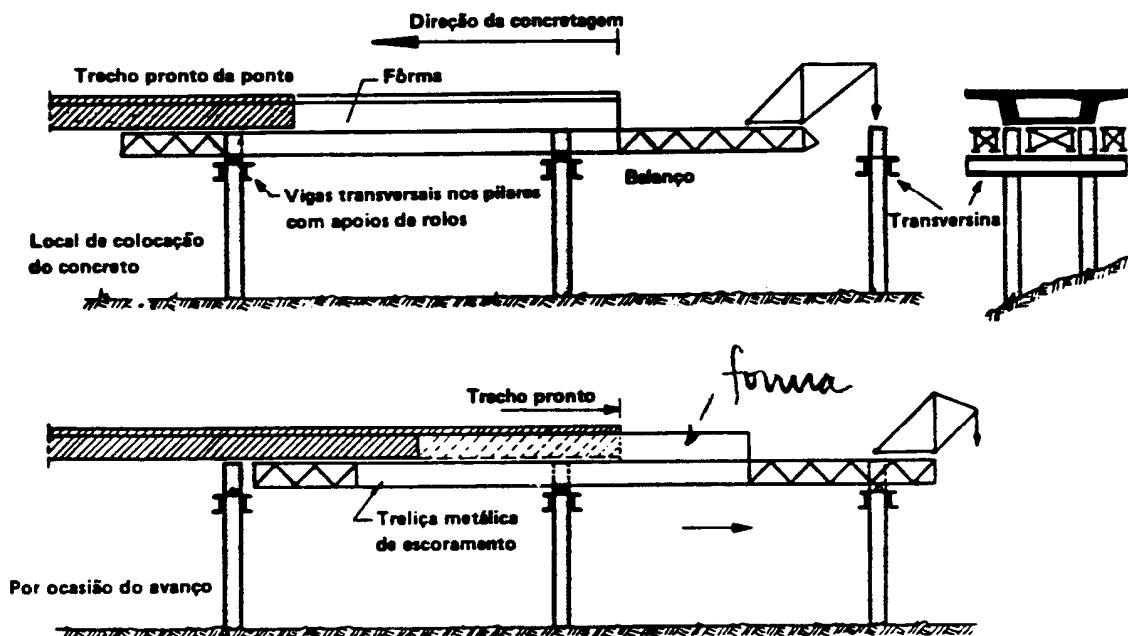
Execução, vão por vão, por meio da treliza de escoramento deslizante sobre rolos dispostos em vigas transversais (Leonhardt, 1979).
